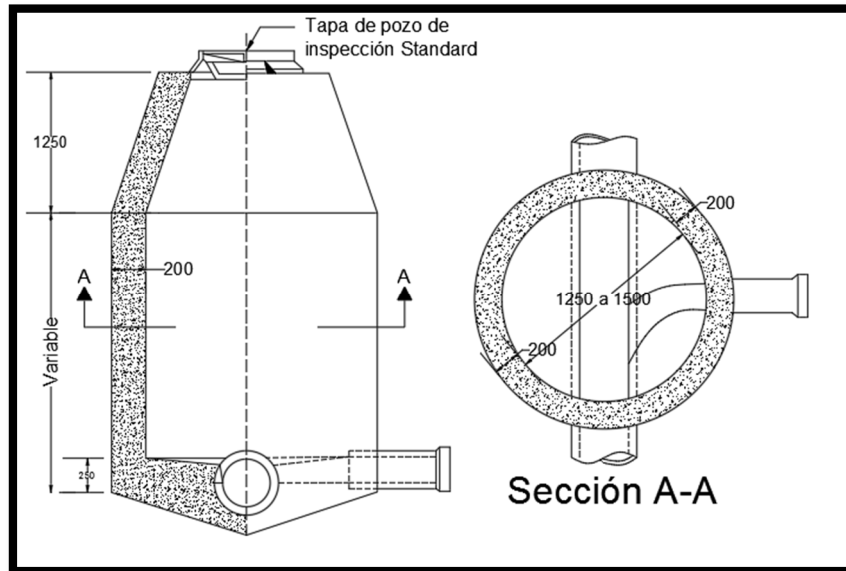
Pozo de inspección de concreto con unión de alcantarilla ramificada.
